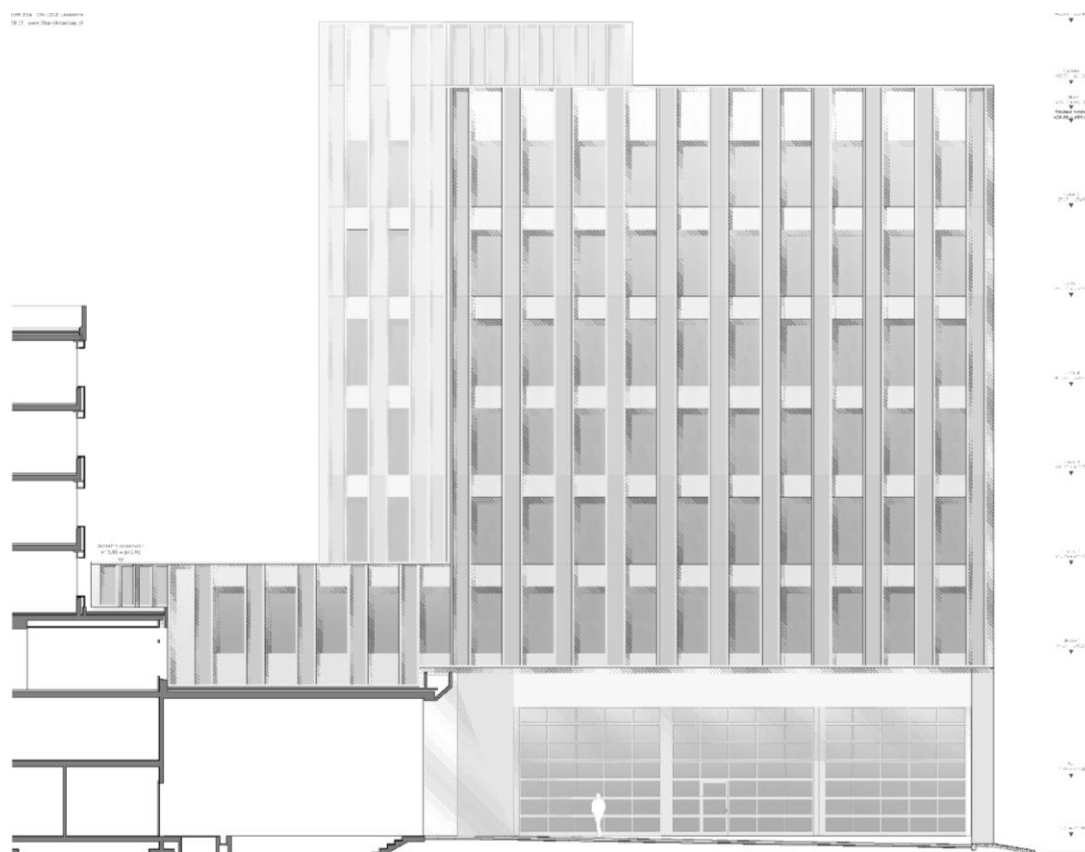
La façade BATPOL côté place de la caserne des pompiers
